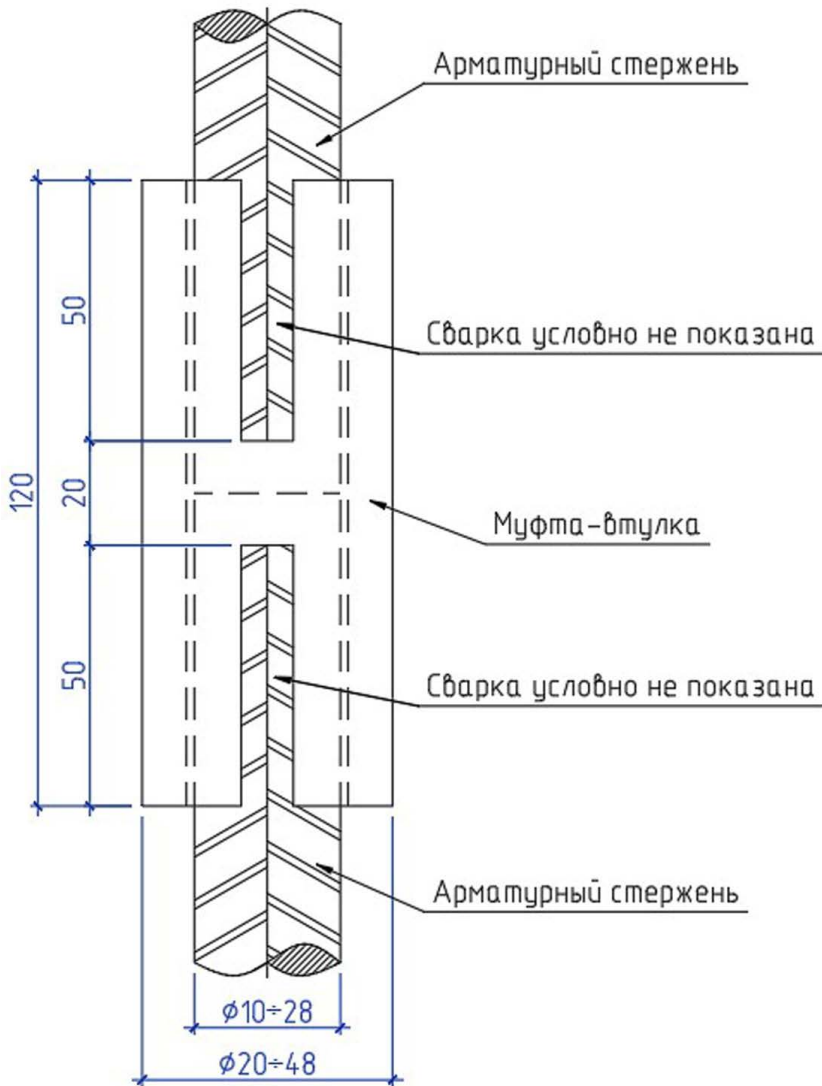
Схема сварного соединения арматурных стержней с помощью металлической муфты-втулки с прорезями для сварки
